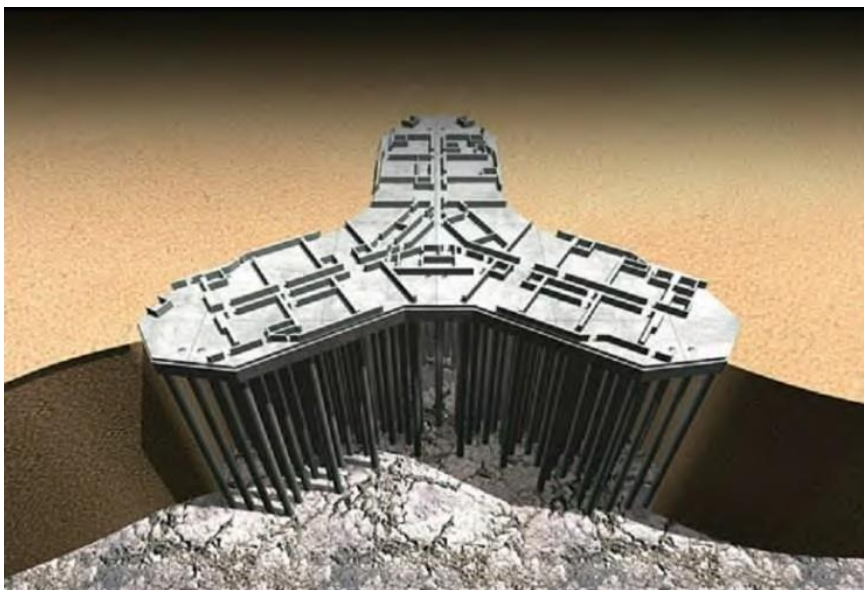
Схема фундаментів Бурдж-Халіфа
